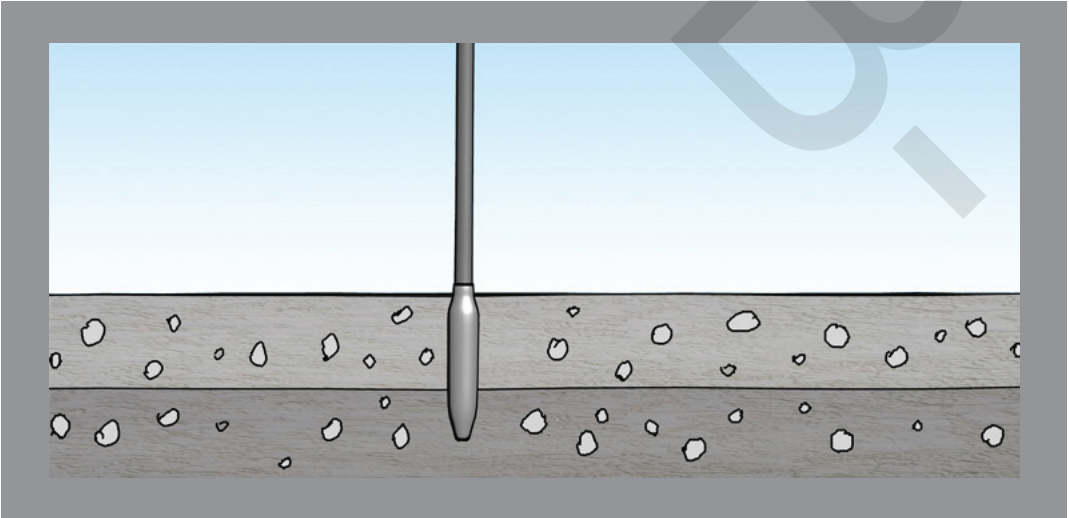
Kütleli beton işlerinde beton eşit tabakalar halinde dökülmelidir. Aksi halde betonun sıkıştırılması güçleşir.
